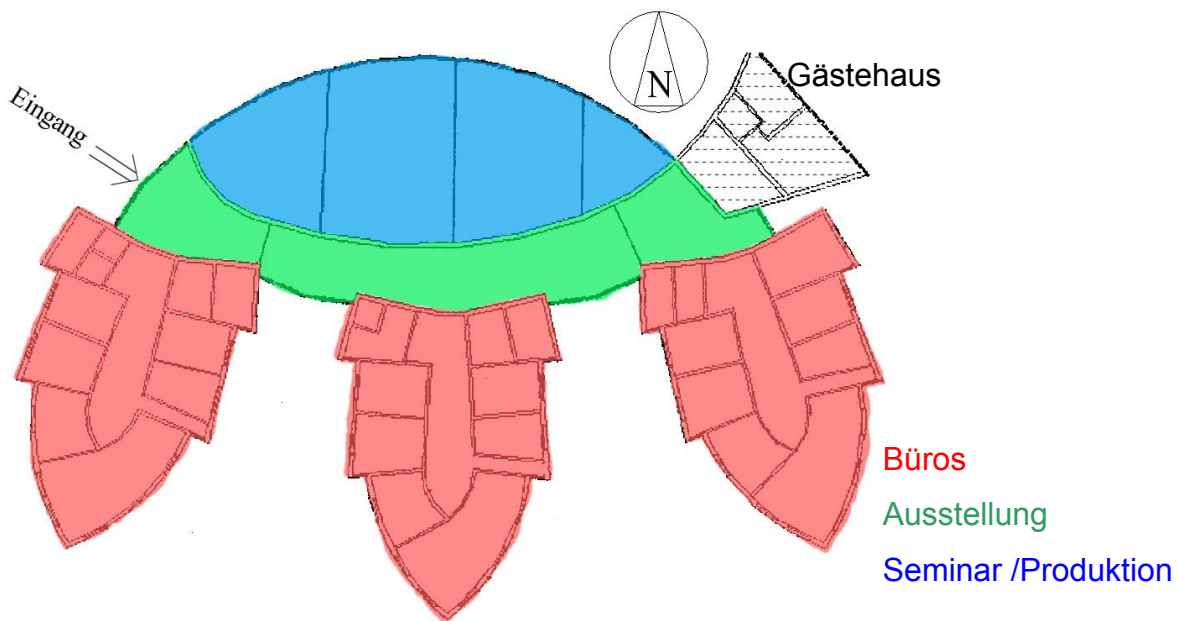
Schematischer Grundriss: Erdgeschoss des Artur-Woll-Hauses. Das Gästehaus befindet sich in dem schraffierten Bereich.
